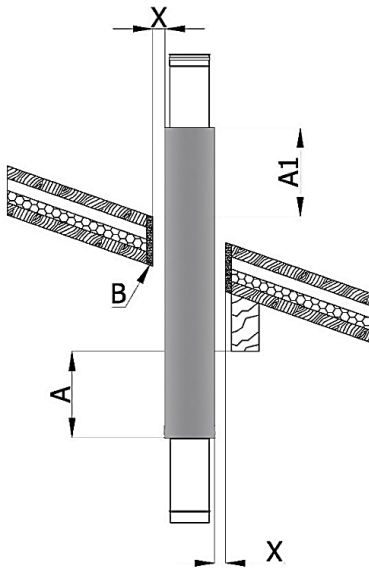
Attraversamento a tetto ventilato con travetto trasversale
